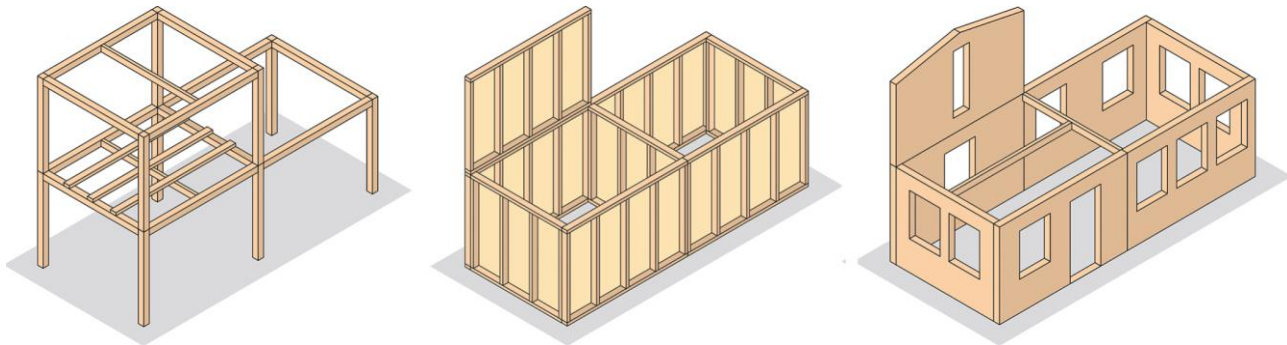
Übersicht über Holzbauweisen für den mehrgeschossigen Holzbau [45]
